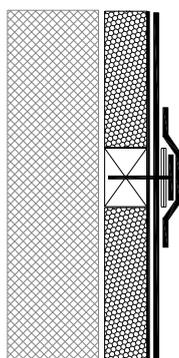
Zwischenbefestigung an aufgehende gedämmte Bauteile mit Holzbohle und Verbundblech
